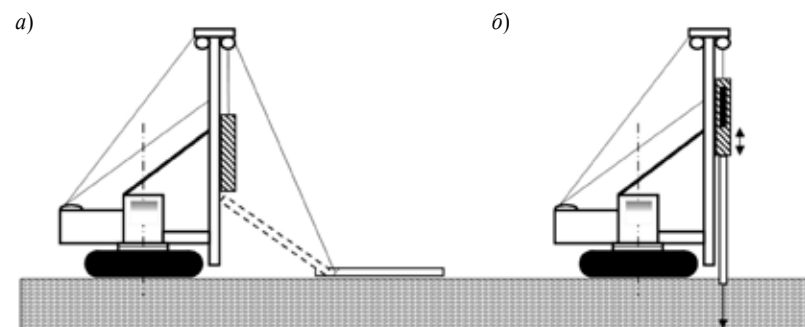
Схема организации работ по погружению свай: а – подтаскивание и подъем сваи на мачту копра; б – забивка сваи
